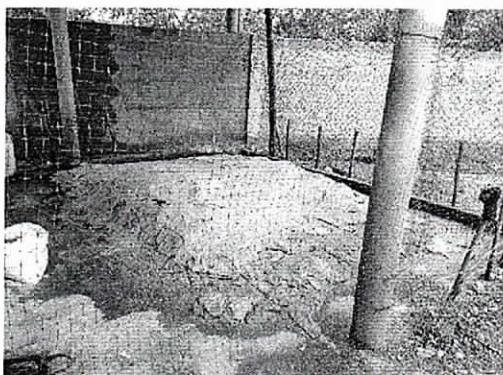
,5: Área de secado de cueros. Planta de Sacrificio de Animales NAGED. Mingueo - 10 de Mayo de 2018.
